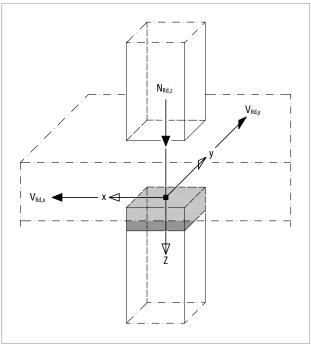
Raccordement de poteau en cas d'isolation sous la dalle
